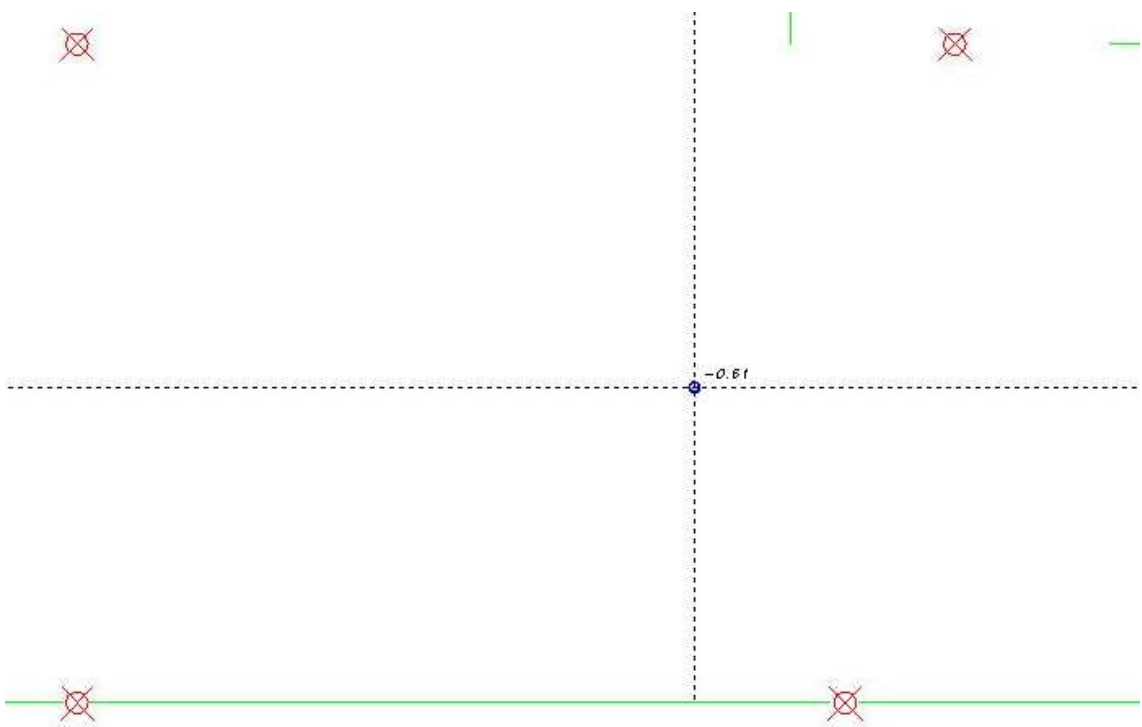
Deslocamento vertical(cm) da laje lisa na região dos pilares P13, P16, P17 e Parede 2 via Eberick
